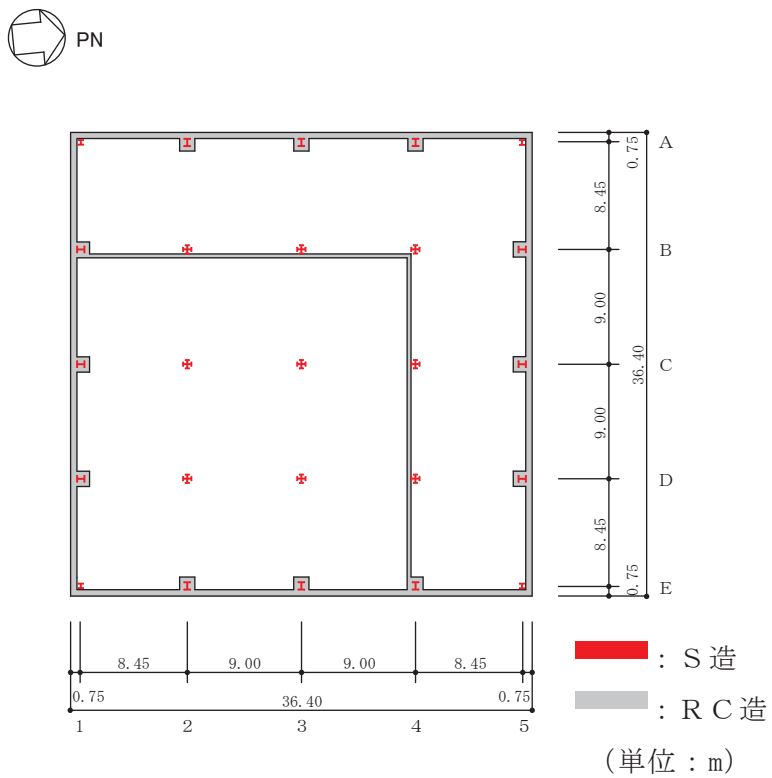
(4) 緊急時対策建屋の概略平面図 (0.P. 69.4m)
